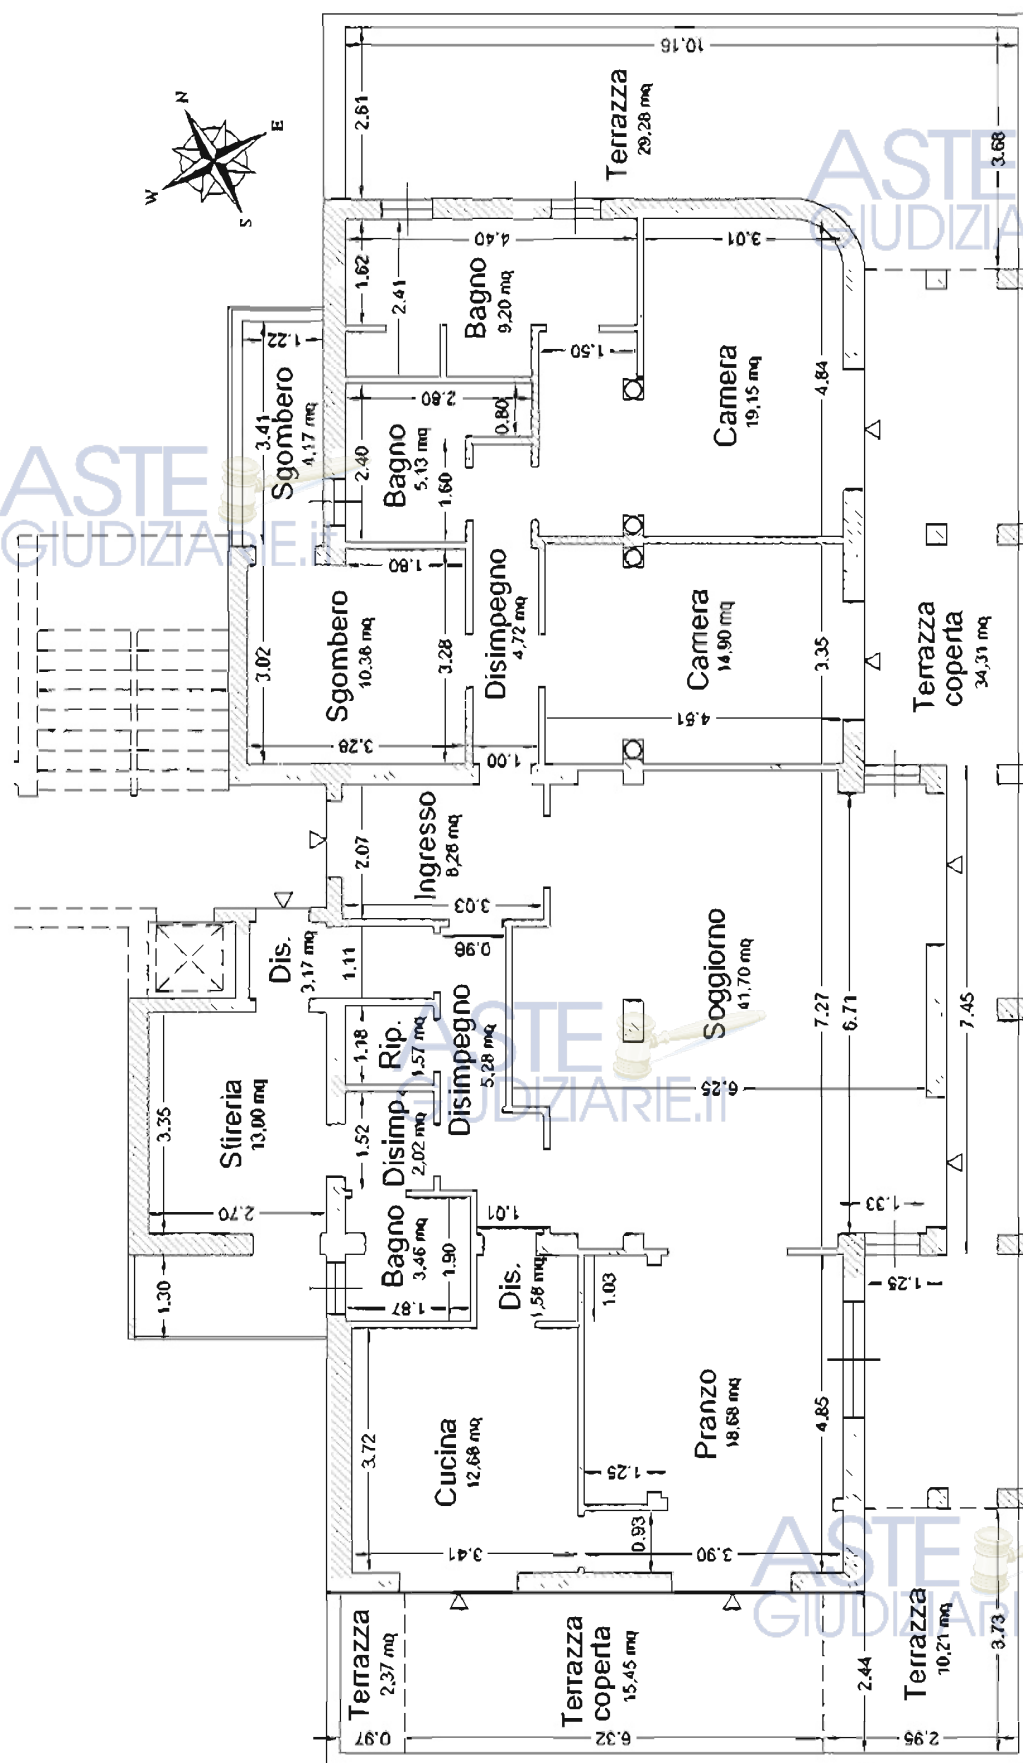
Planimetria catastale 2017 - Pianta piano settimo
